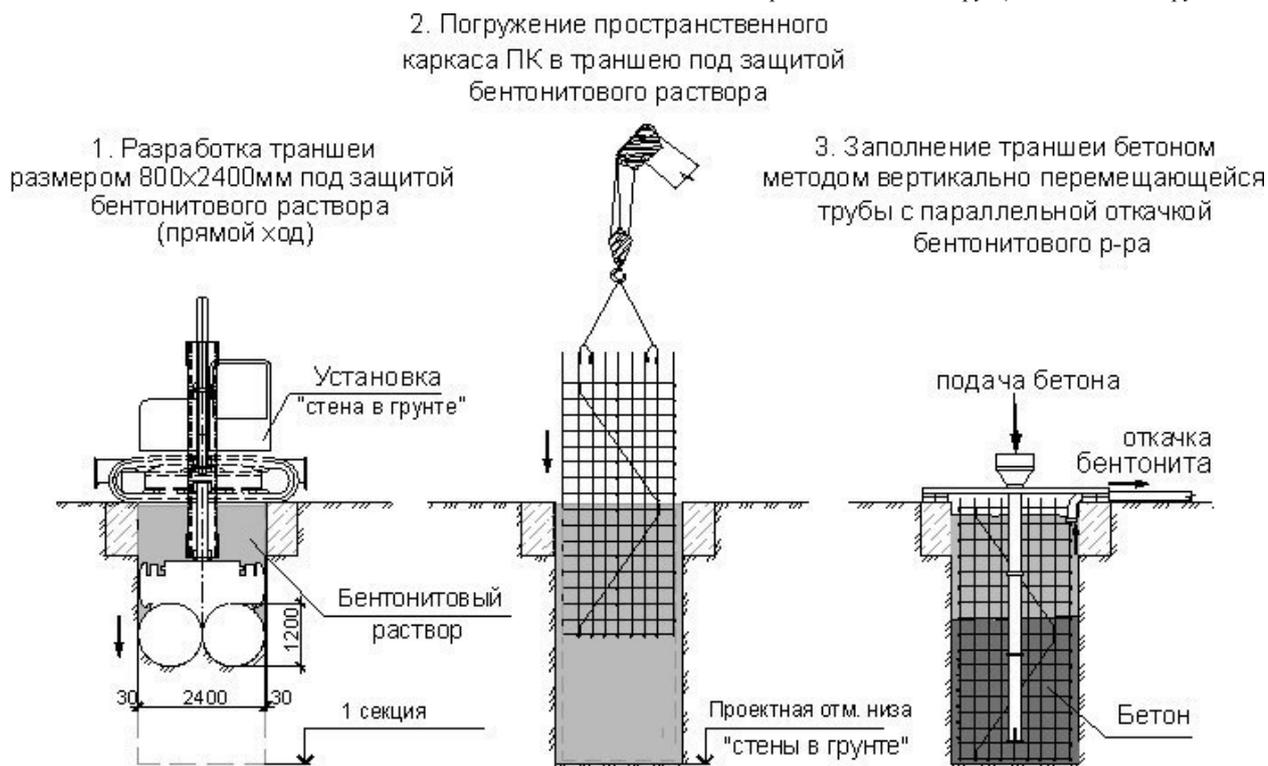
Разработка грунта буровой установкой на захватке гидрофрезой под защитой бентонитового раствора
